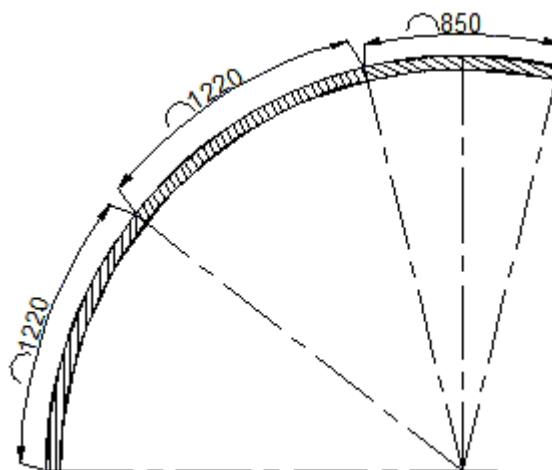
Dimensiones de piezas de la lámina cilíndrica
